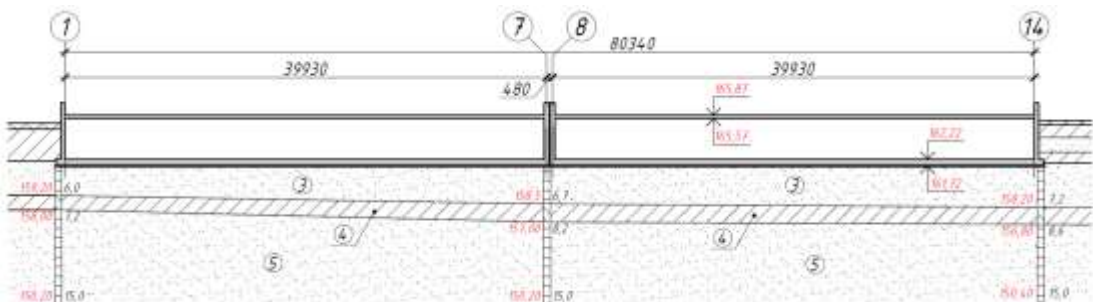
Посадка фундаменту на інженерно-геологічний розріз
